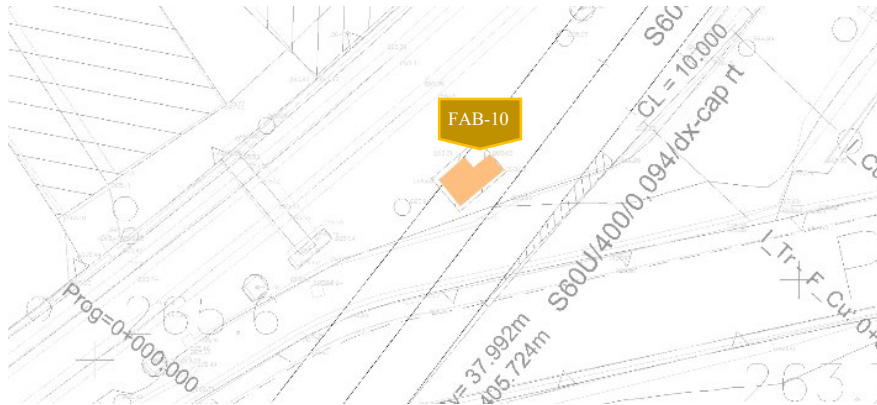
Stralcio planimetrico zona via Piè di Virgolo
